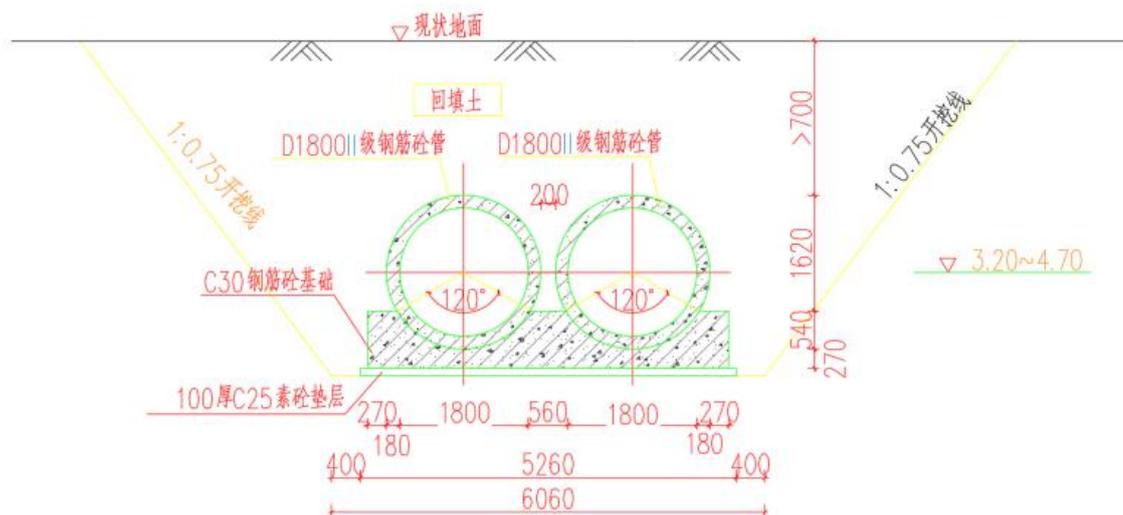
2 根 D1800 钢筋砼 II 级管剖面图
